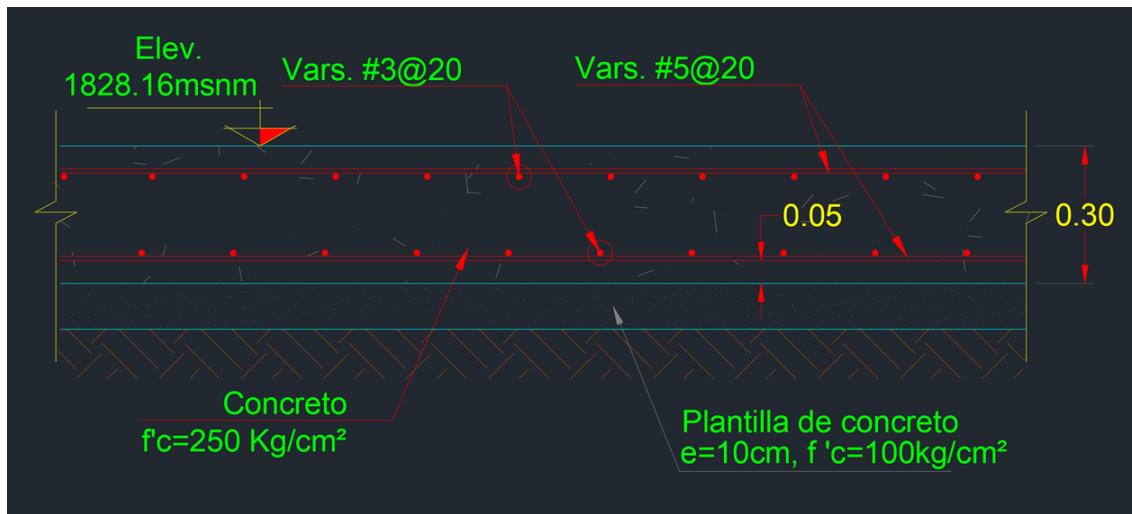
Armado de la Losa del Tanque Amortiguador
